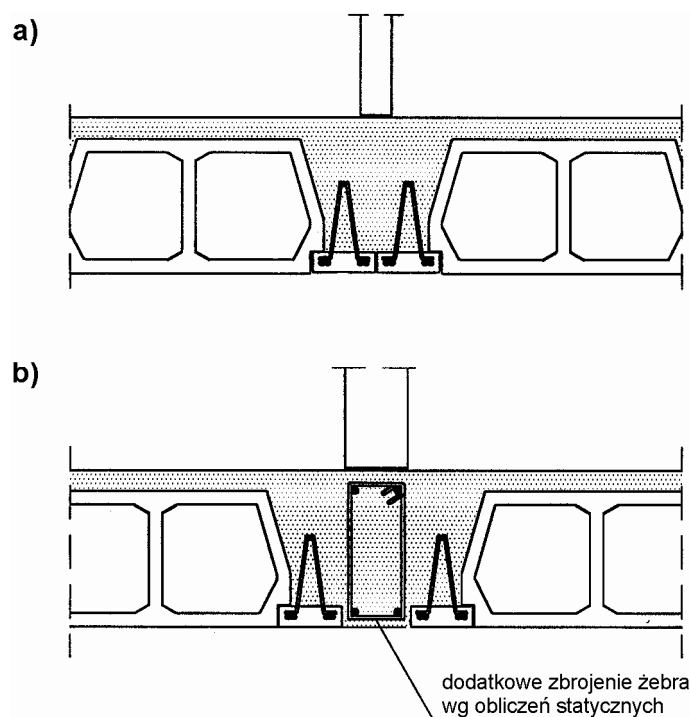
Przykład przekroju przez żebro rozdzielcze
